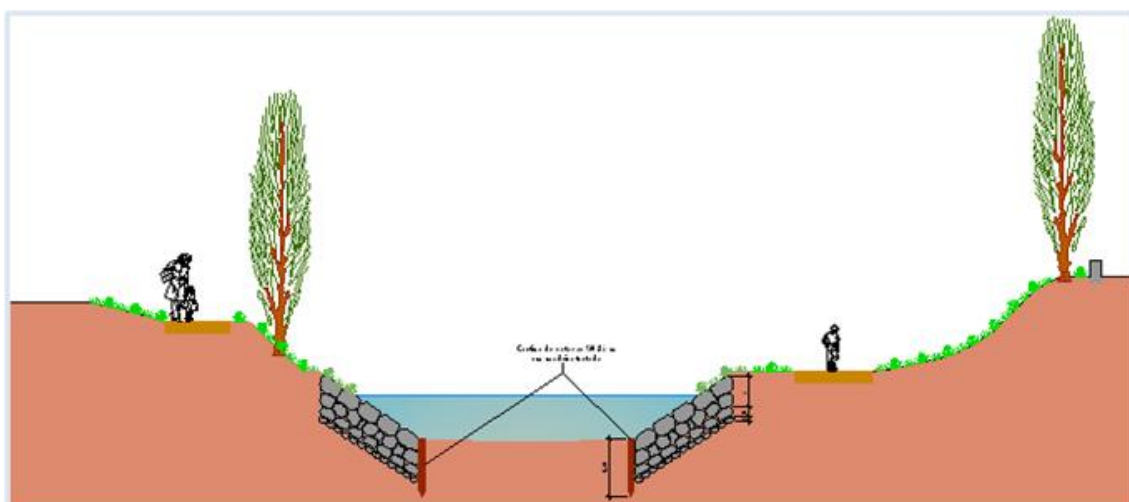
b)– Perfil transversal tipo do Rio Este após a intervenção - Barros, (2009)
